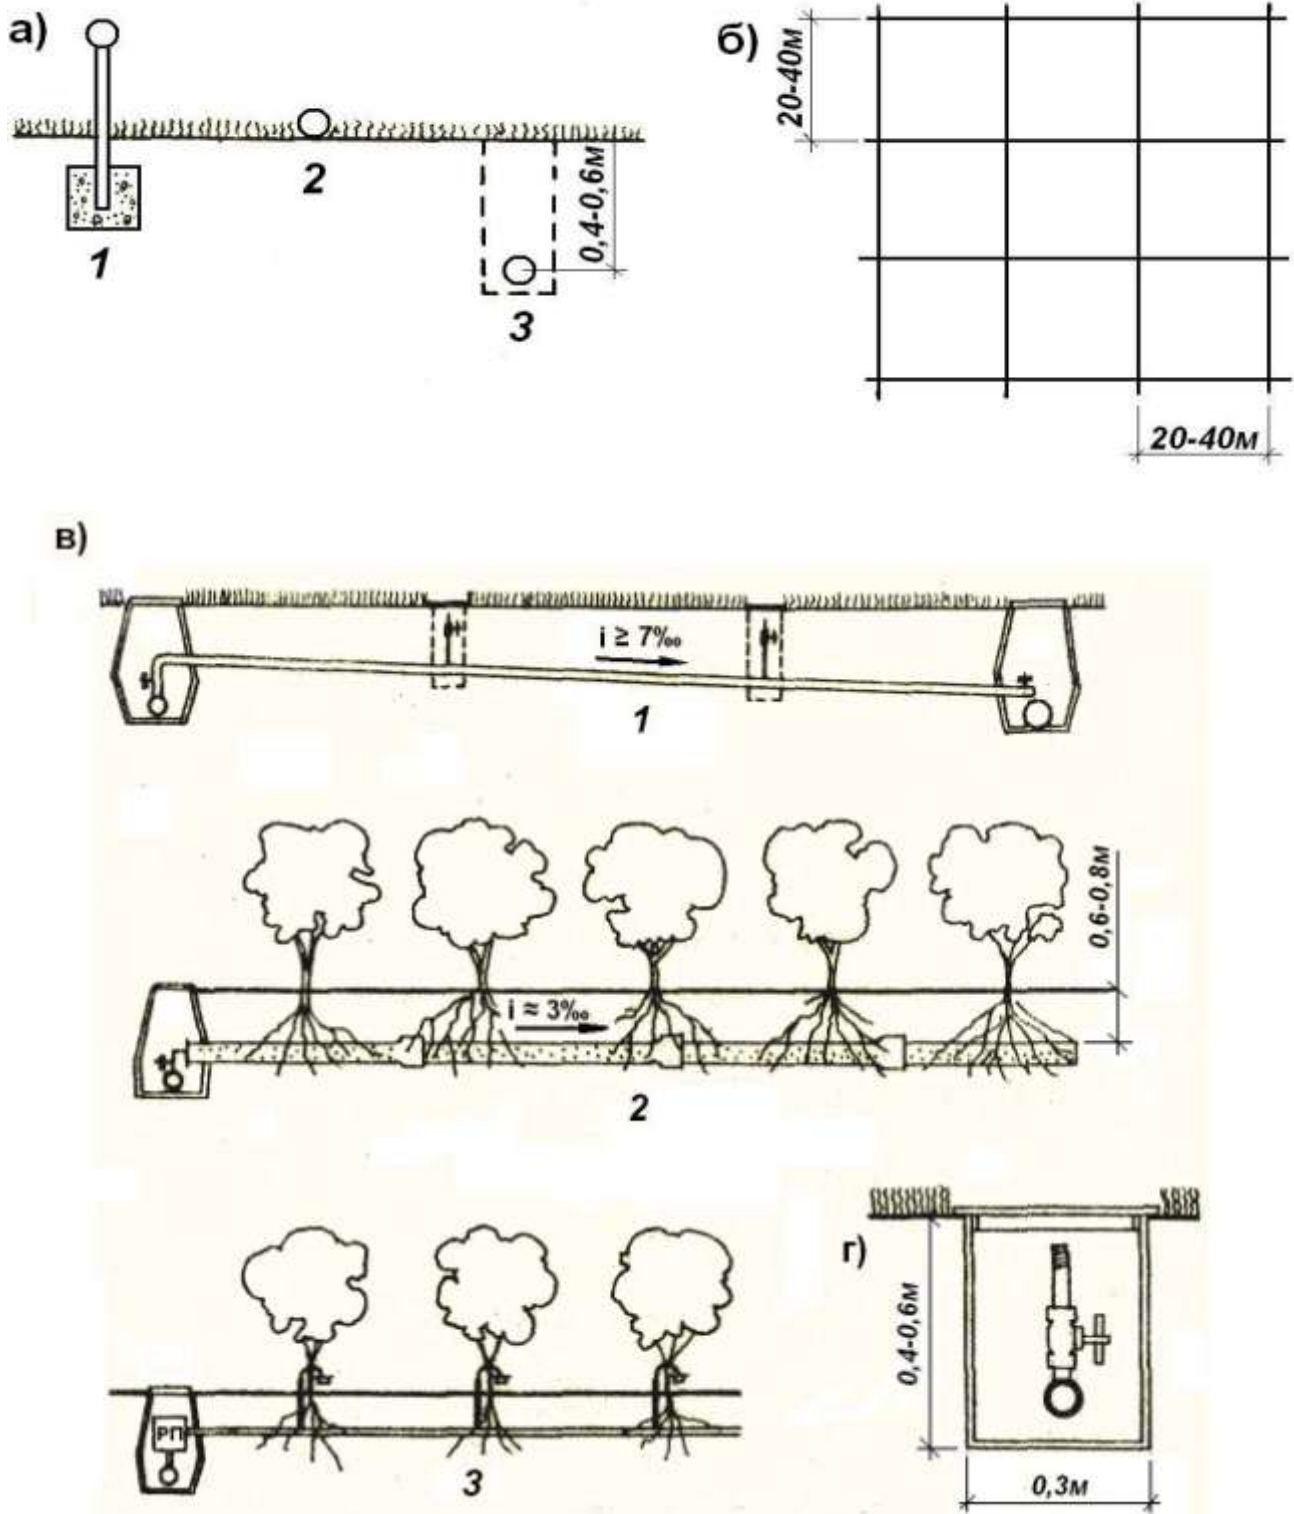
Конструкції поливального водопроводу: а) розміщення по відношенню до поверхні землі: 1 – надземне; 2 – наземне; 3 – підземне; б) схема розміщення коверів; в) поздовжні профілі підземних поливальних водопроводів: 1 – звичайний; 2 – дренаючий; 3 - краплинний; г) конструктивний розріз ковера
